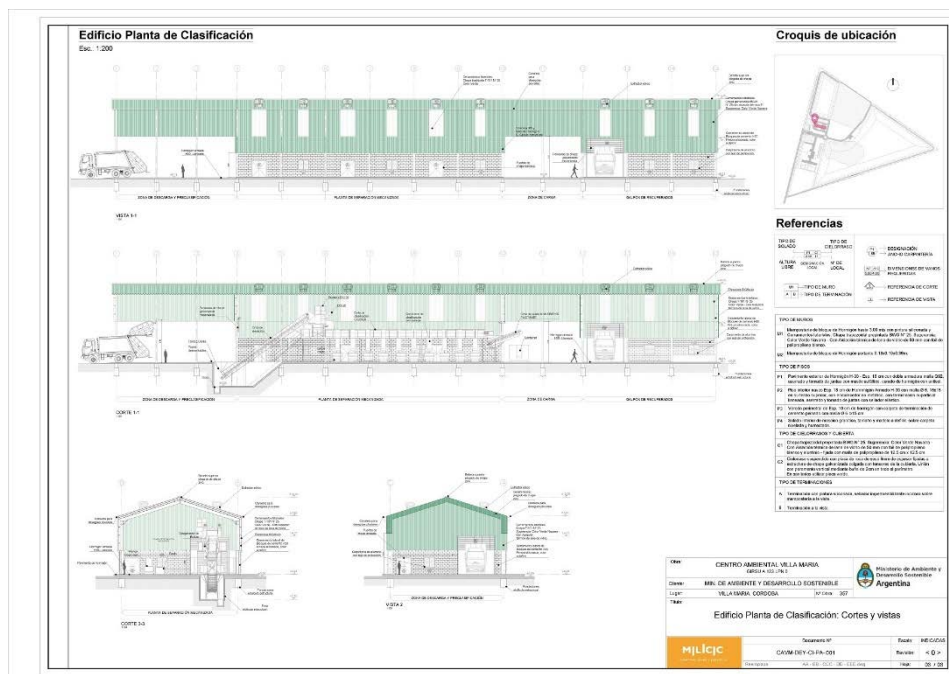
Villa María - Planta de Separación y Clasificación – Vista lateral.
